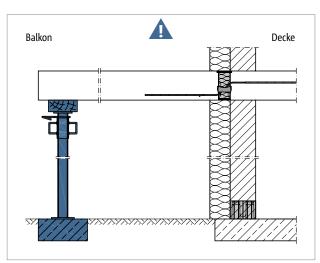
Schöck Isokorb® T Typ QL: Stützung durchgängig erforderlich
